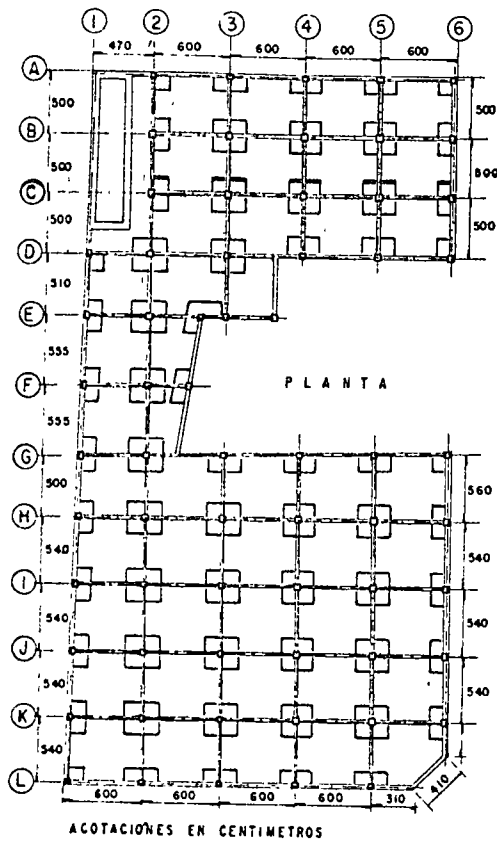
Planta de cimentación del edificio ubicado en el sitio 10.
